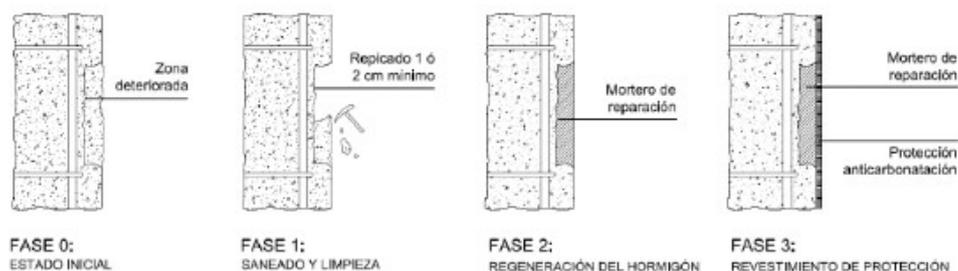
Fases de la reparación de pilares con hormigón en mal estado
